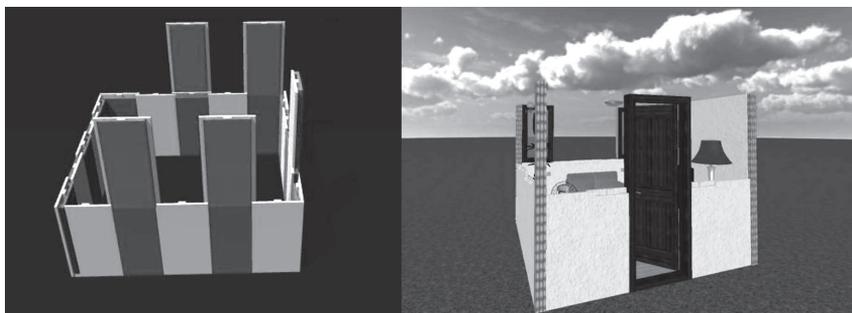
Prototipo de vivienda a base de paneles de concreto ligero reciclado
